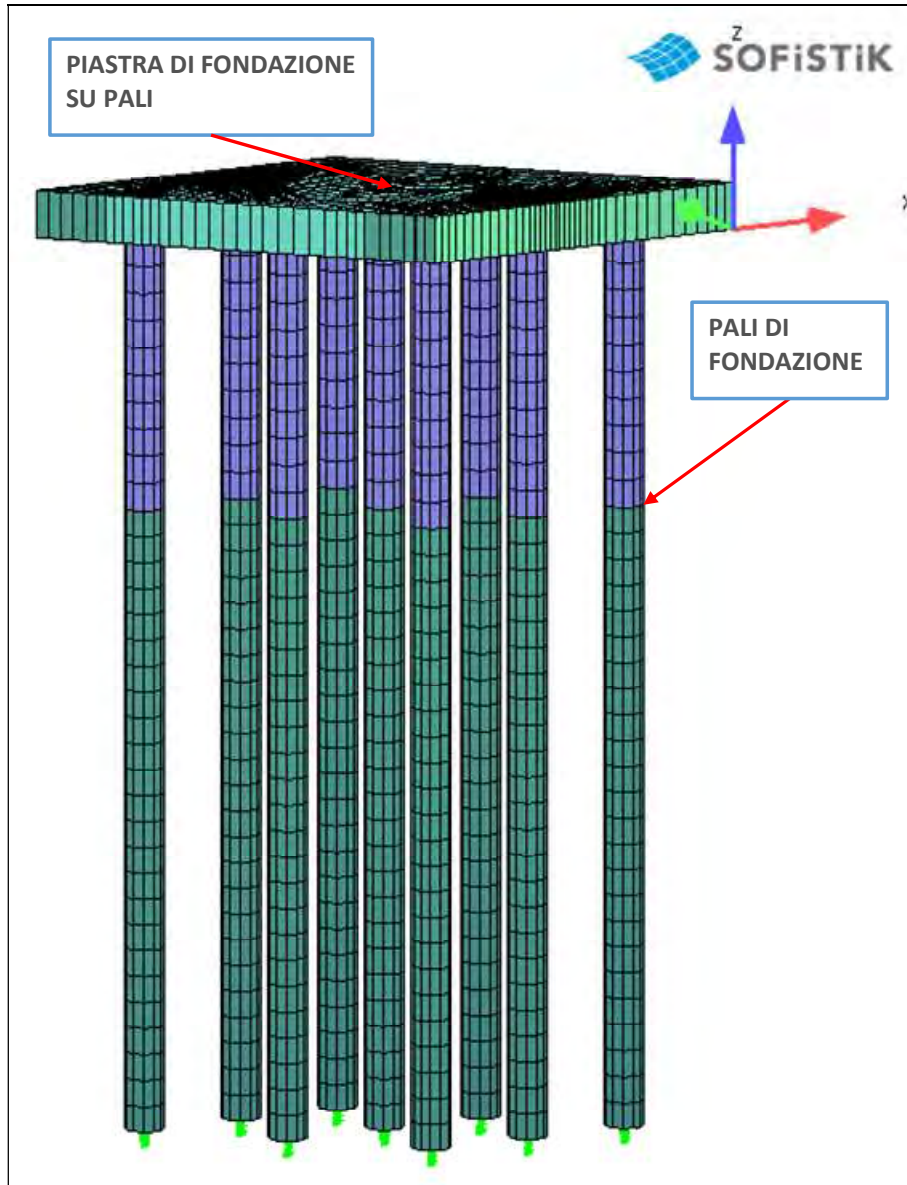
Modello globale spalla: piastra e pali di fondazione
